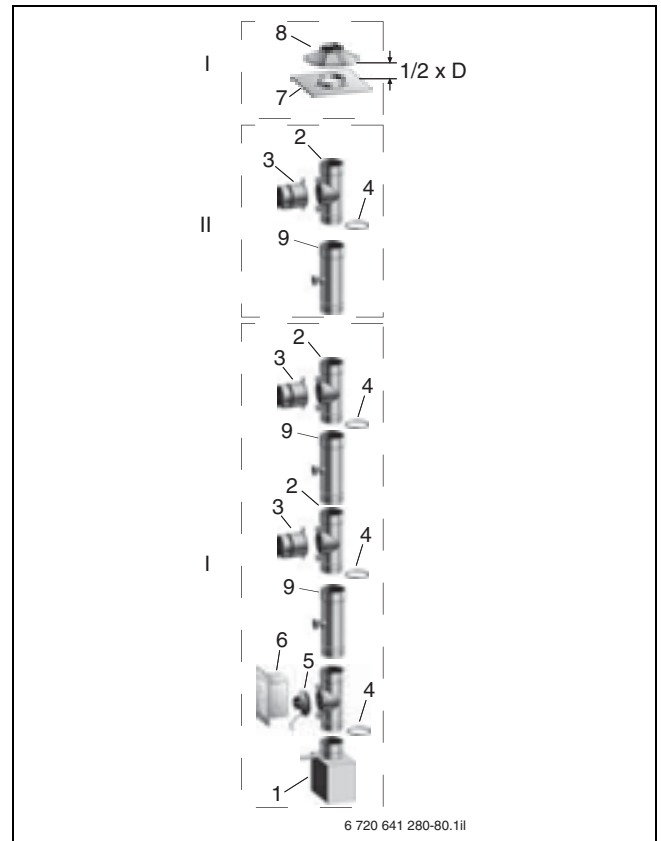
Bauteile des Bausatzes Mehrfachbelegung
